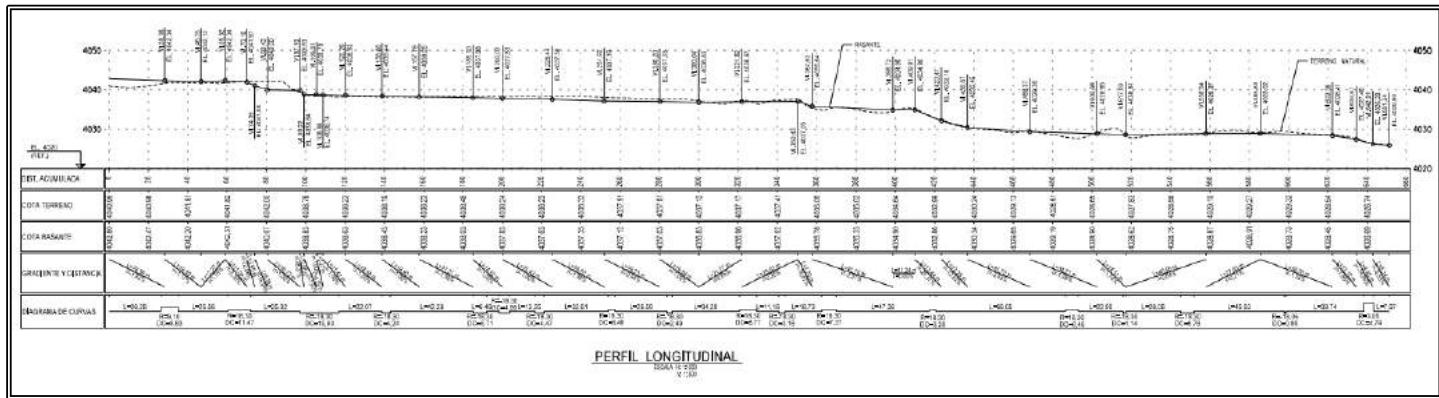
Perfil longitudinal de Línea de Tubería hacia Poza Sur
